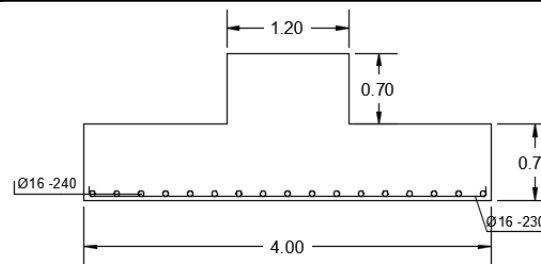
ferrailage de la semelle sous poteau de rive avec palée de stabilité en X
